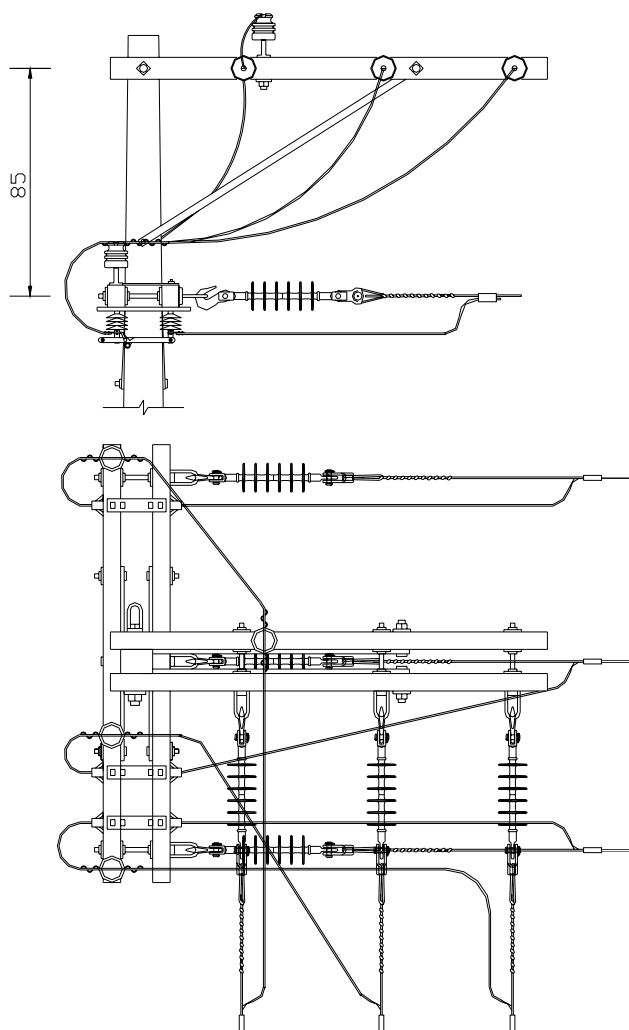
Estrutura B3-N3 (derivação chave faca)
